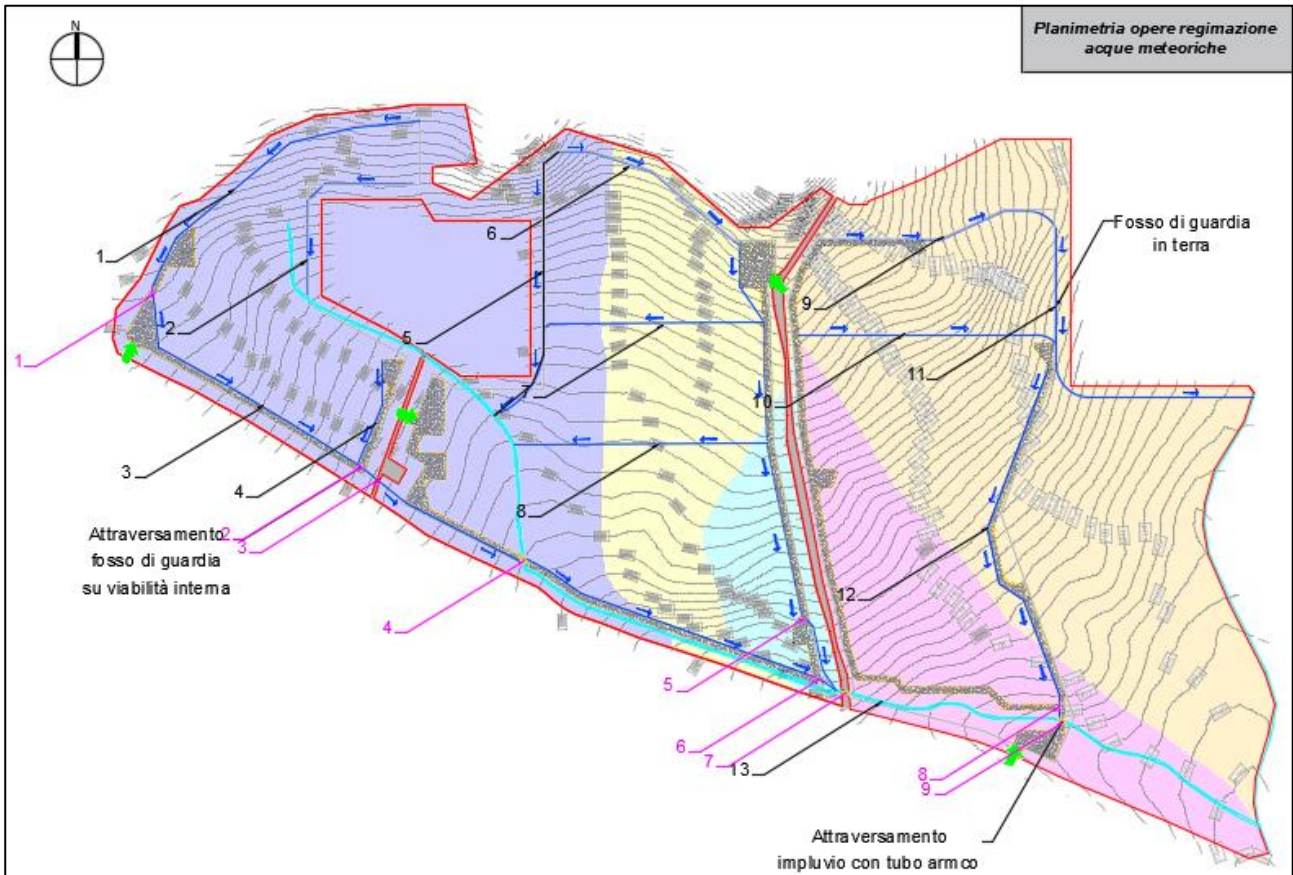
Stralcio planimetrico ubicazione opere idrauliche
